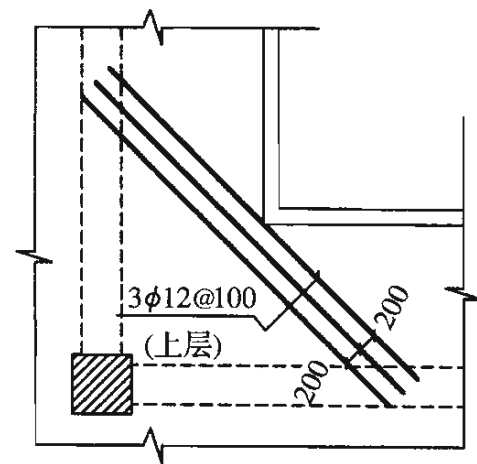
挑檐转角位于阴角时的加强配筋
